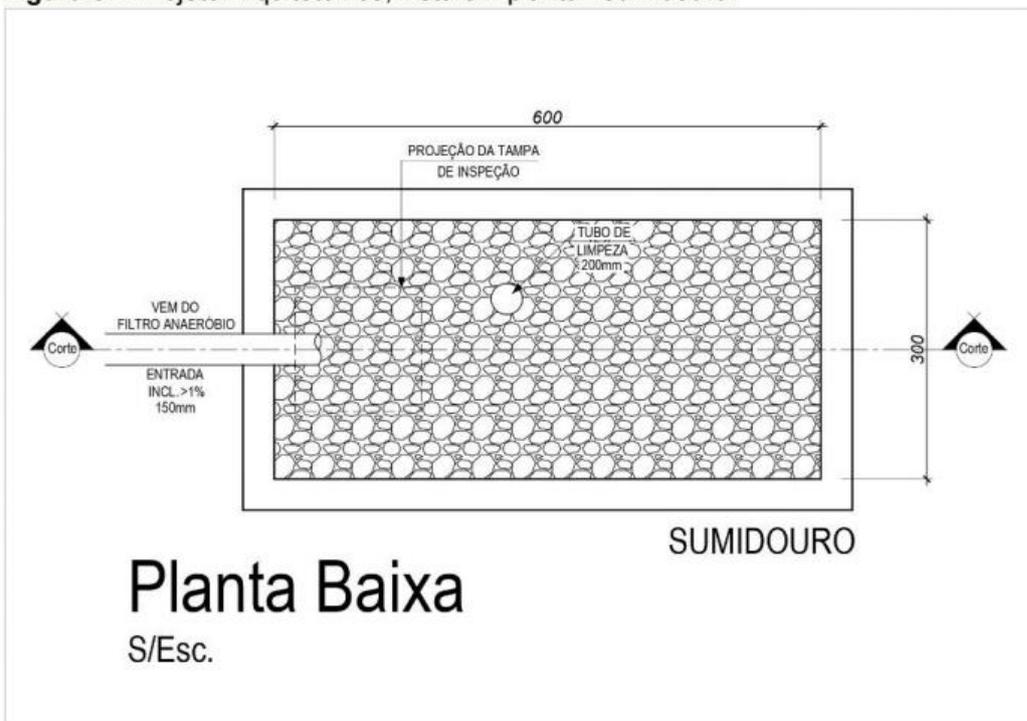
Projeto Arquitetônico, vista em planta –sumidouro.
